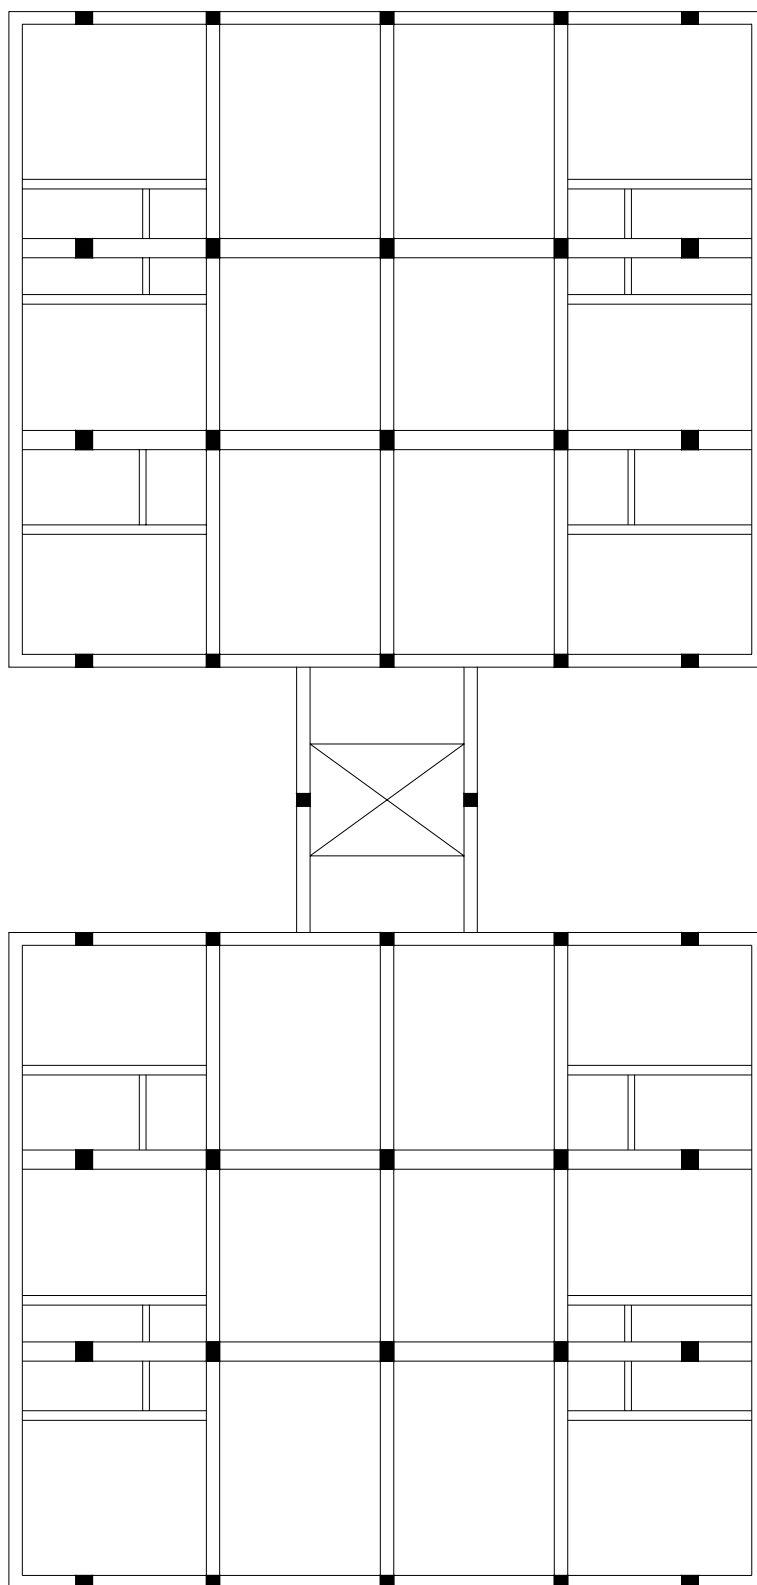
Residencial “G” – Esquema do Vigamento do Pilotis
